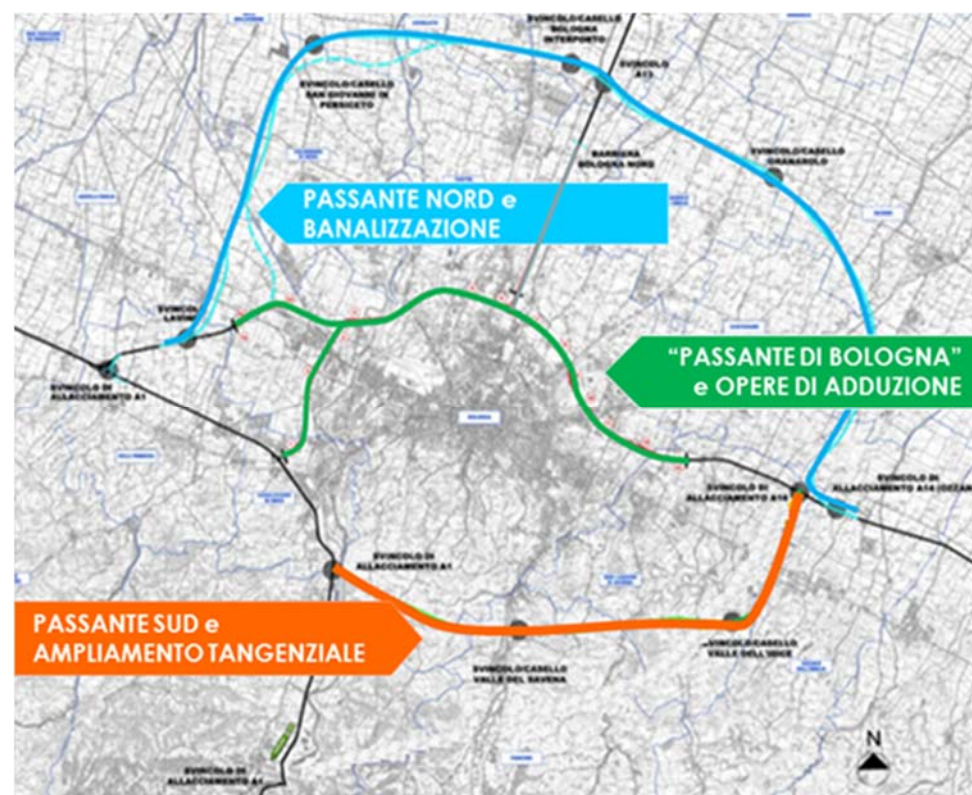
Le alternative di tracciato (fonte: Progetto preliminare)
